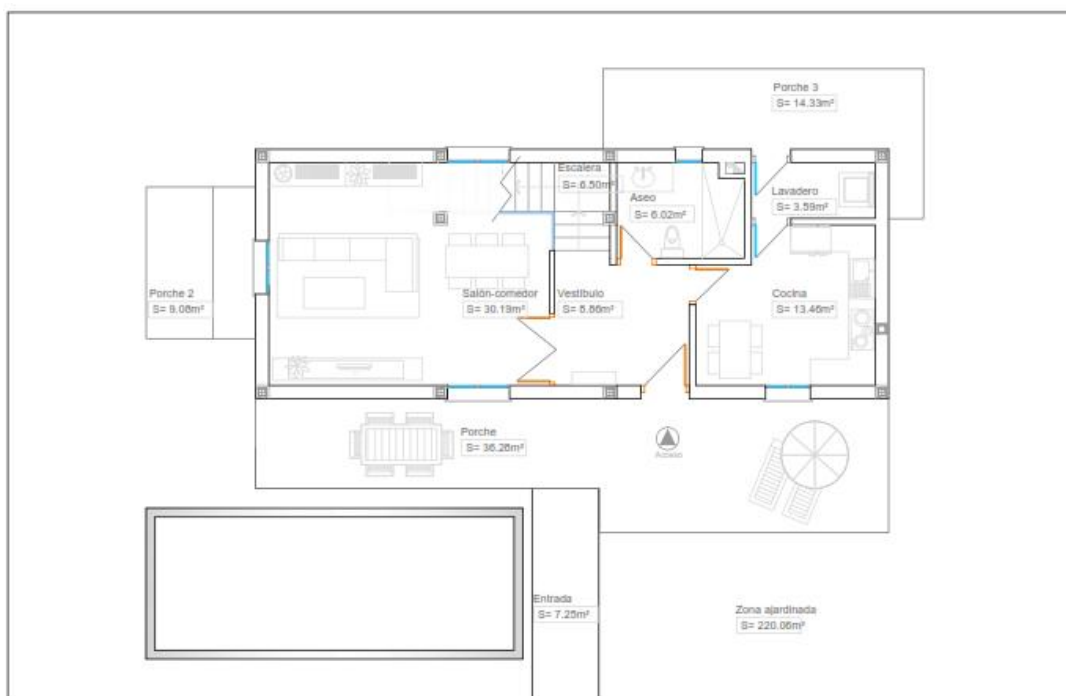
Plano de distribución de la planta de baja del inmueble con su parcela.
